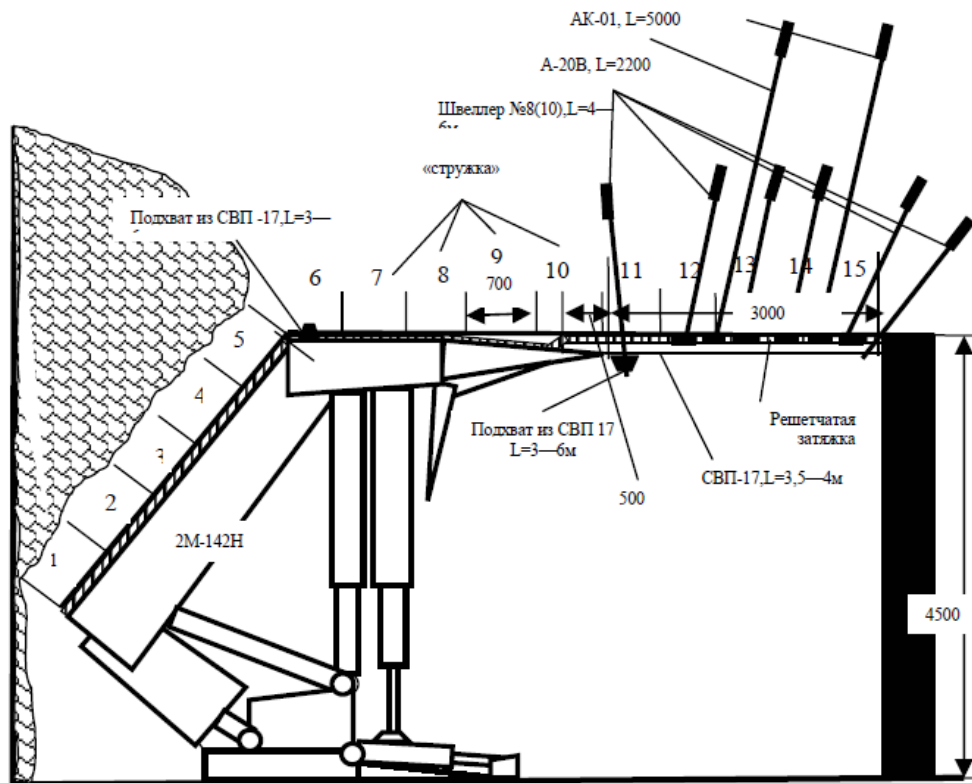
Схема подготовки демонтажной камеры №1362 [9].
